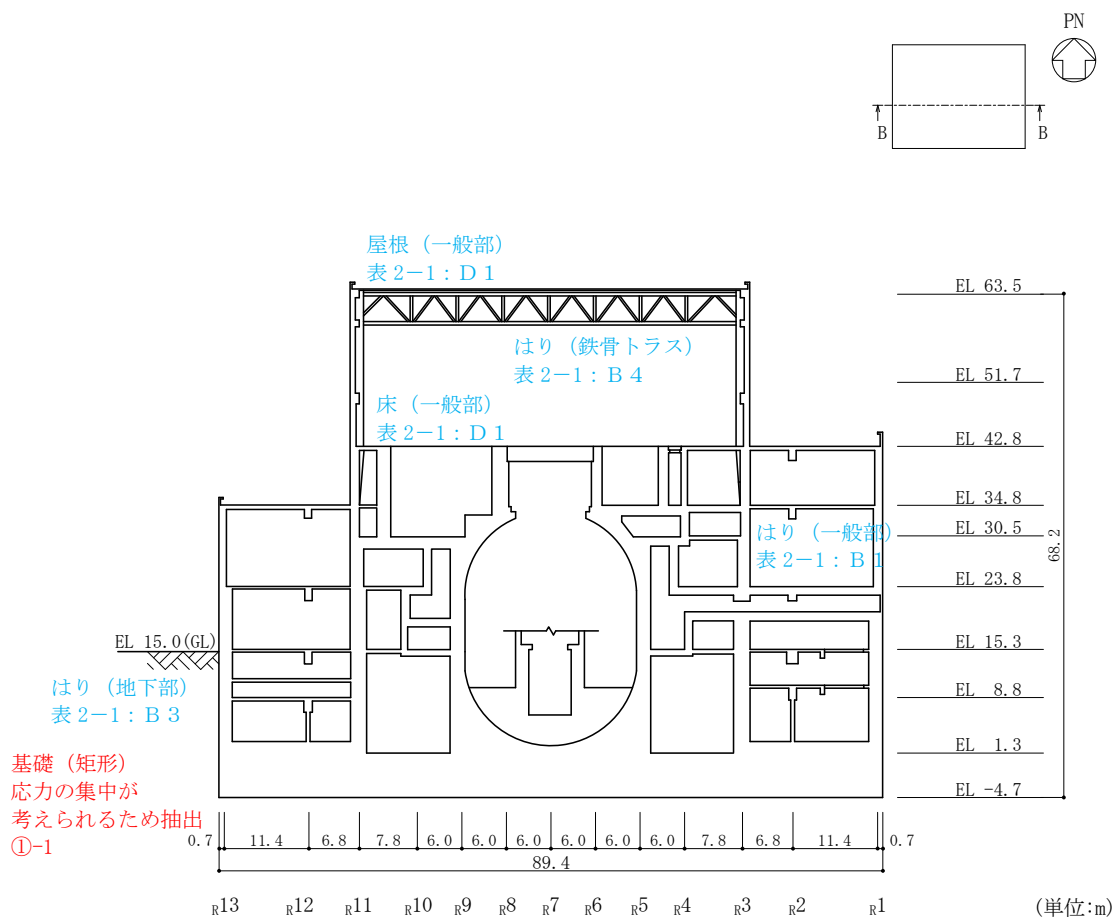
(2) 原子炉建物の概略断面図 (B-B 断面, EW 方向)
